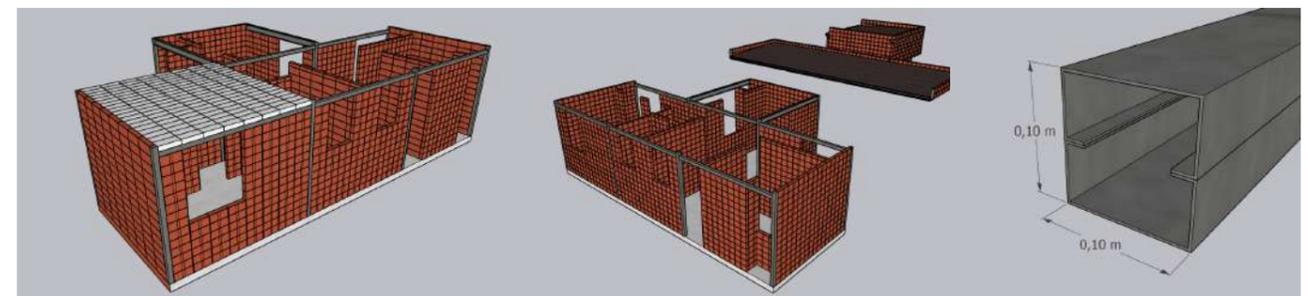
e 31: Encaixe (parede / viga / laje). e Detalhe da estrutura metálica. Fonte: Autoria Própria. 2024.
